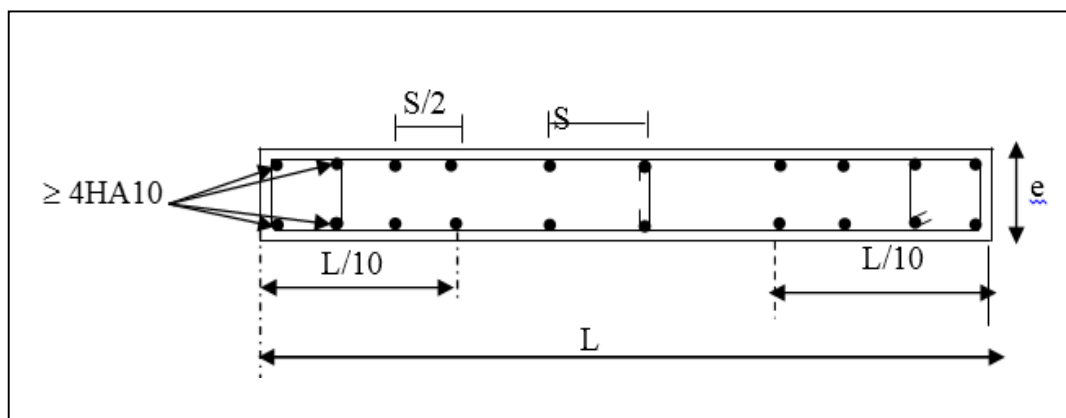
Disposition des armatures verticales dans les voiles.
